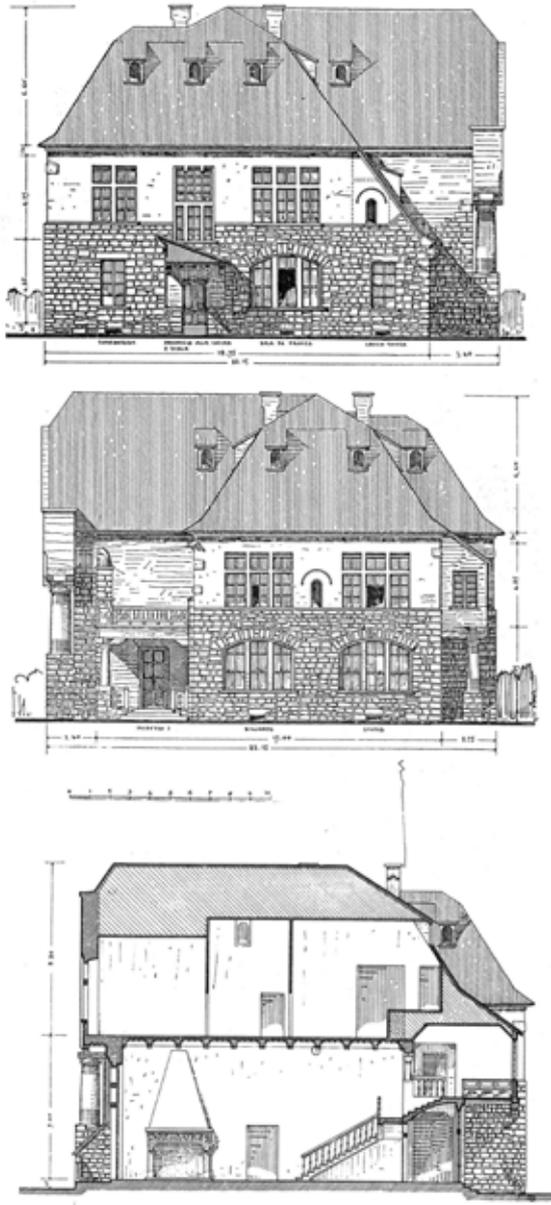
Villa La Montanina. *Cottage*: facciate (est e ovest) e sezione longitudinale.
